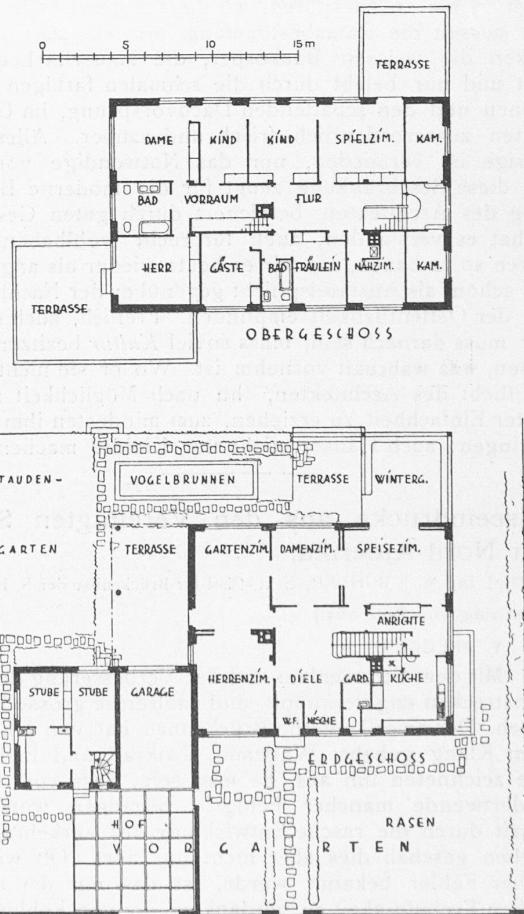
und 5. Grundrisse zum Hause Dr. Charlton in Dahlem. — 1 : 400.
